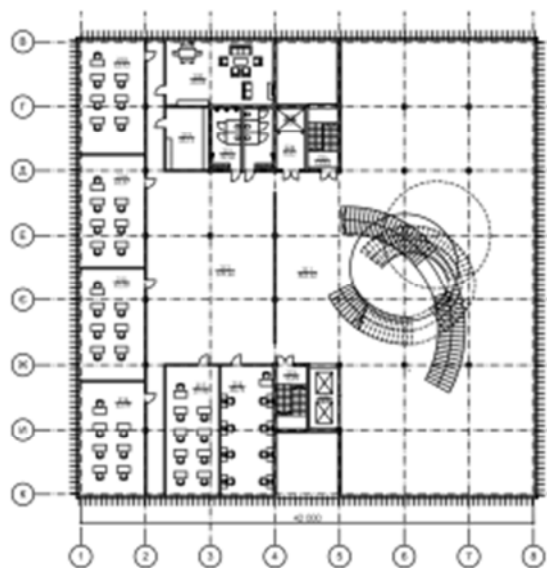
План 2-го поверху на відмітці 5.400 м
